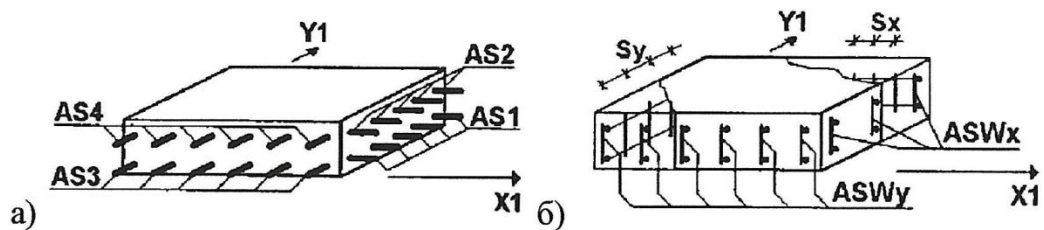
Розташування арматури у перетині капітелей і ригелів:
